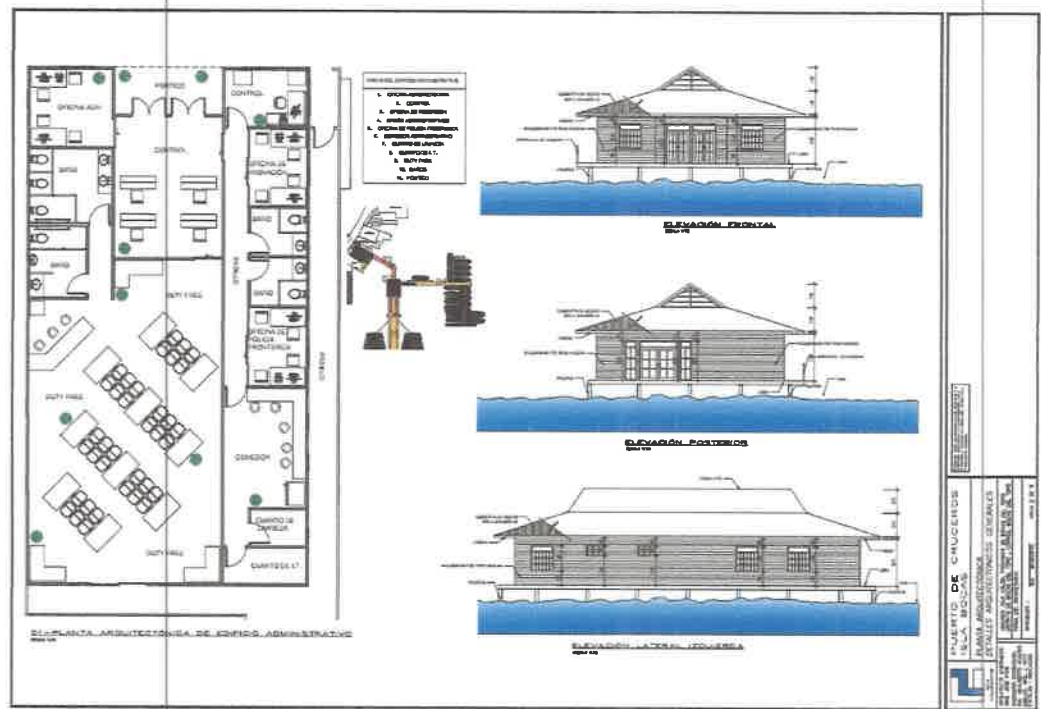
Planta ilustrativa del proyecto: oficinas y restaurante
